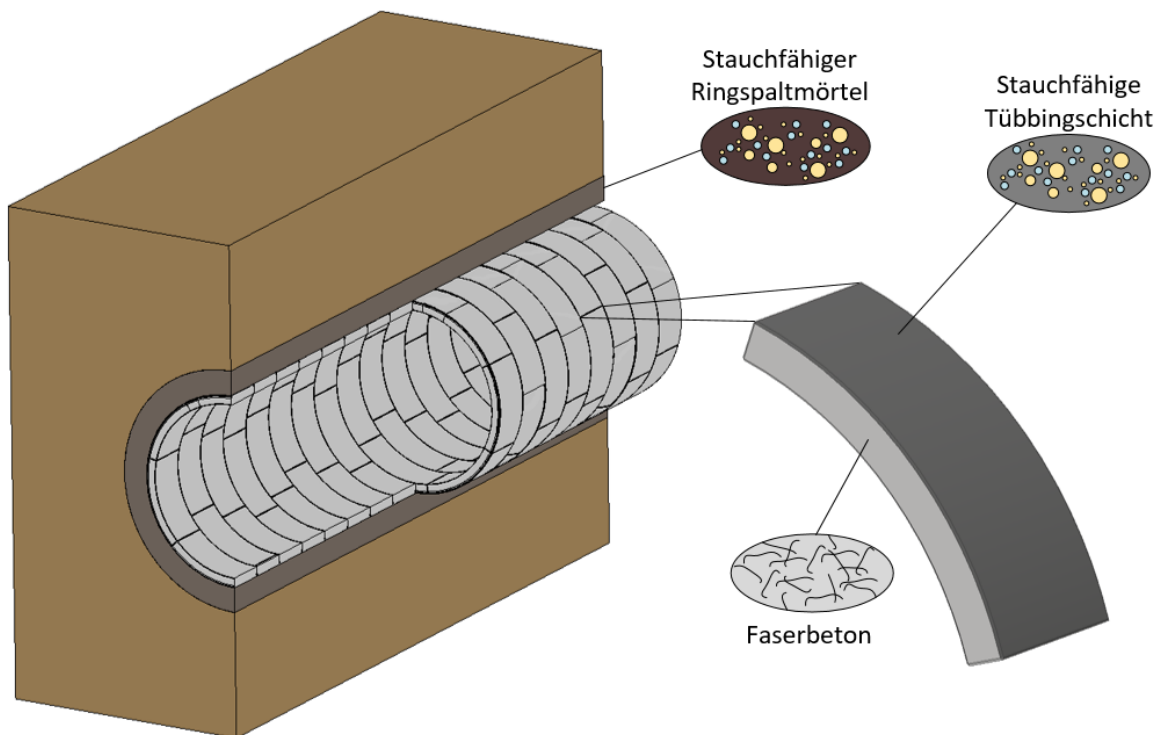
Darstellung eines nachgiebigen Tunnelausbaus
